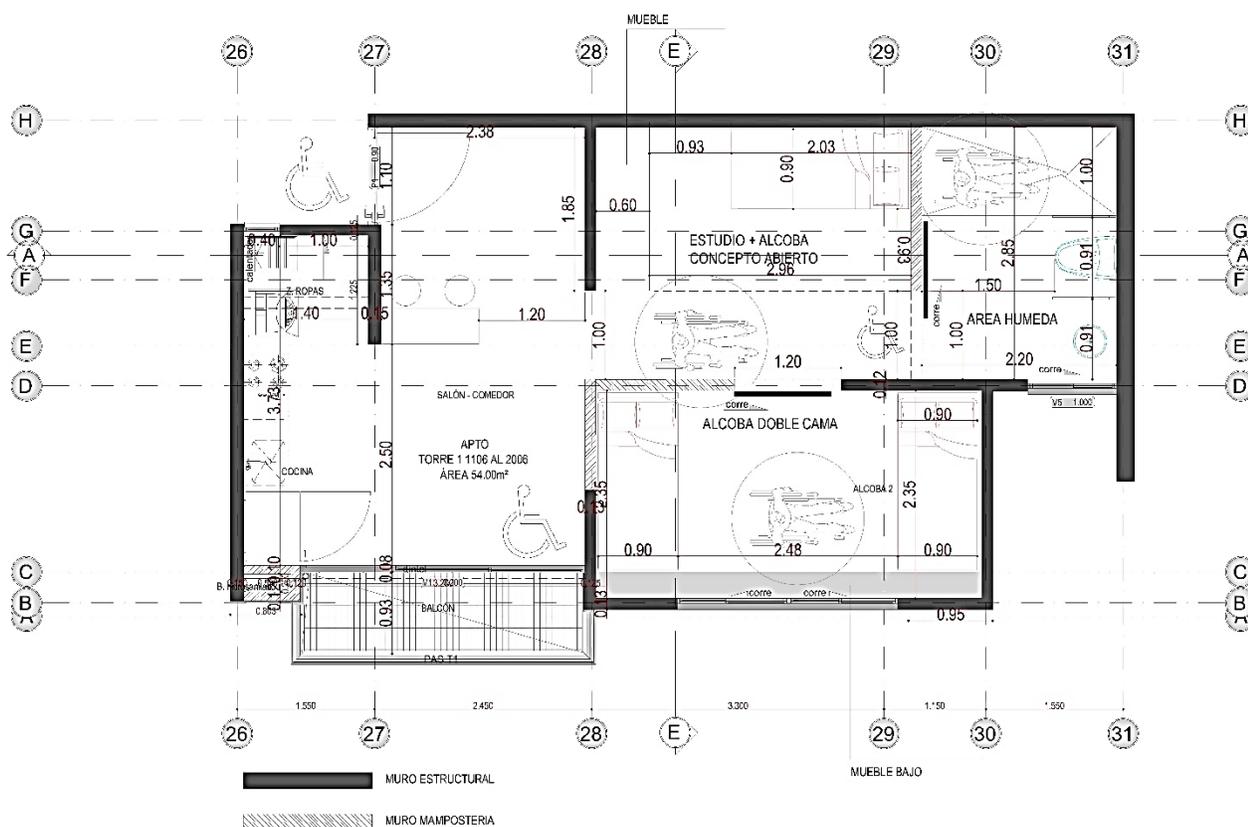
Planta arquitectónica Propuesta Vivienda tipo VIS. (Diseño Propio).
